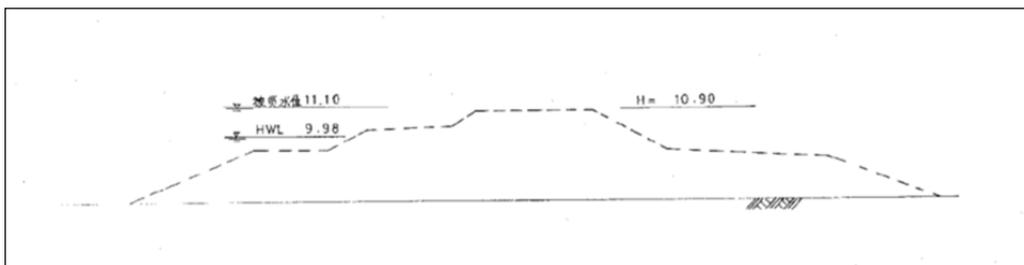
断面図 (⑤幌向川 : 西 1 号橋下流)
